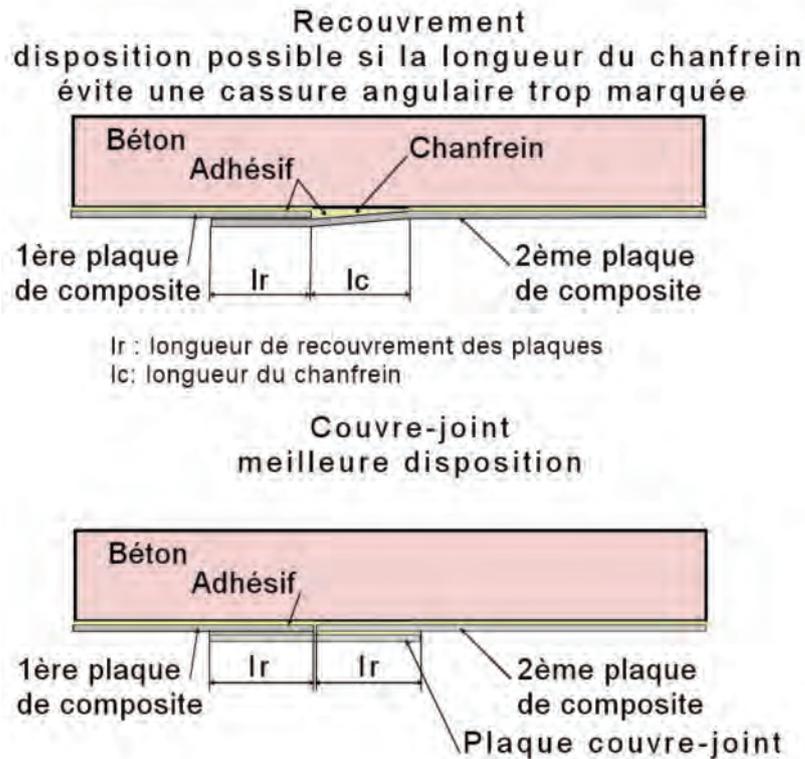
schéma d'un couvre-joint et d'un recouvrement
